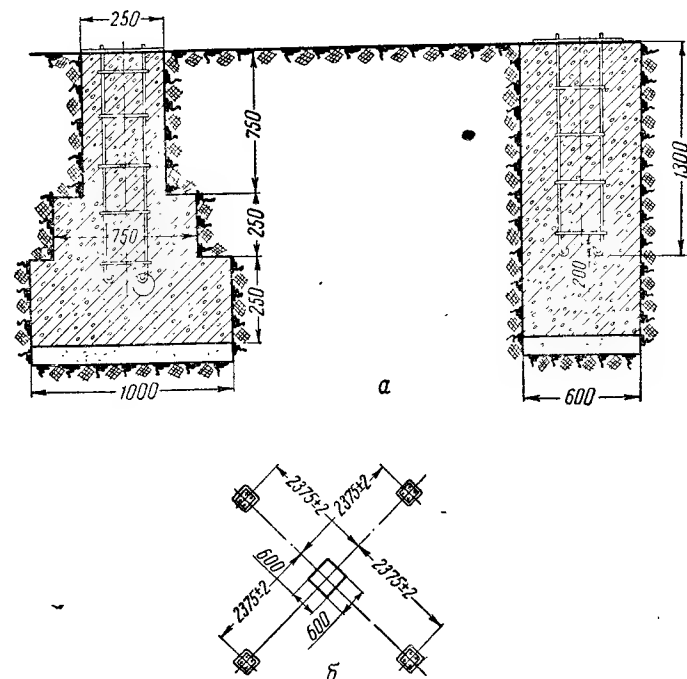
Закладка фундамента ветроэлектрического агрегата ВЭС-1-5:
